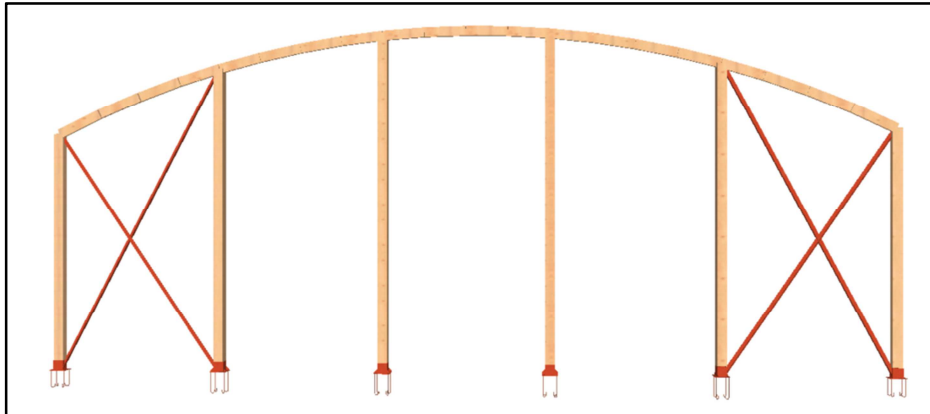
Vista frontal Pórtico de fachada. Fuente: CYPE 3D.
